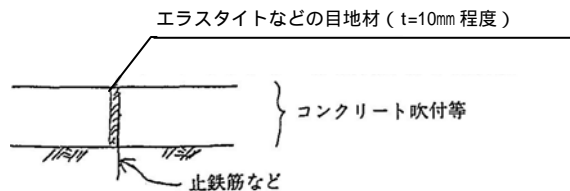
伸縮目地の一例 (断面図) (新斜面崩壊 p193)
